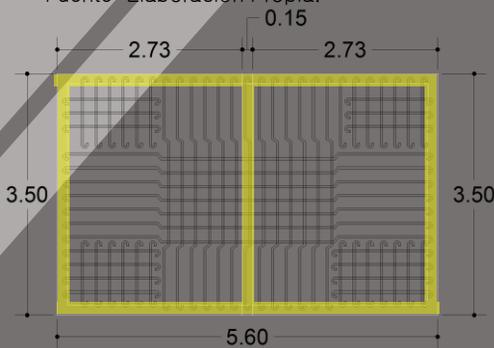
Trabes TC1 en losa maciza de entrepiso.
